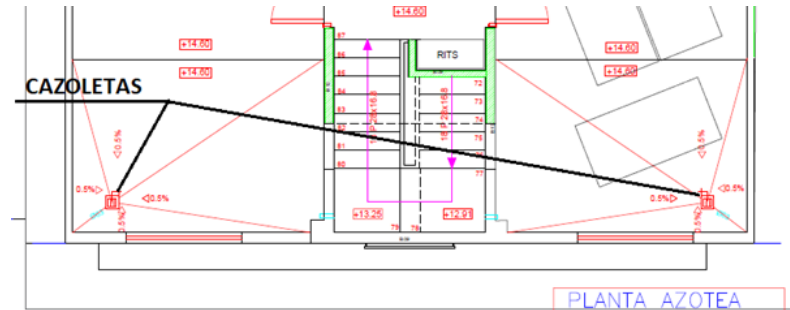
Situación original de las instalaciones, planta de cubierta. Fuente: Proyecto original.
